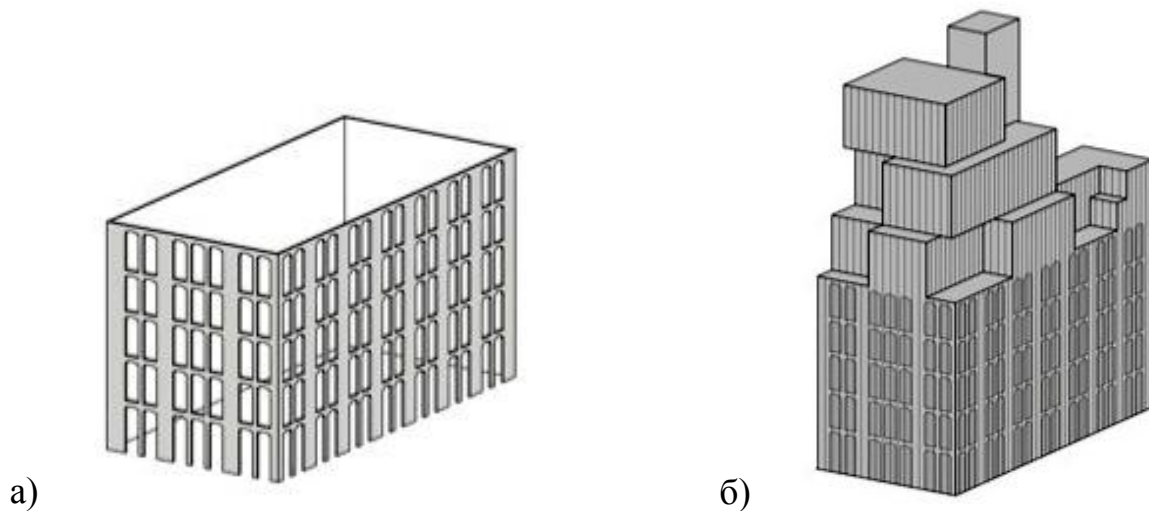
Реконструкція будинку на 15 Юніон Сквеа Вест, Нью-Йорк, США, арх. бюро Perkins Eastman Architects P.C.: а) скляна оболонка, яка розташована навколо історичної будівлі; б) загальна структура будівлі з надбудовою
